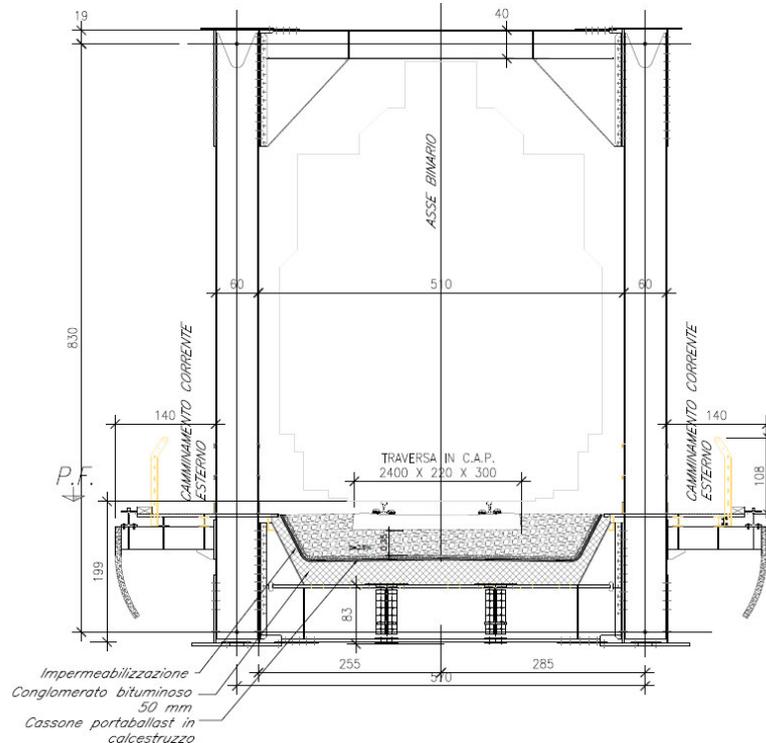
Sezione tipo impalcato del viadotto ferroviario VI01 (Luce=50 m)
